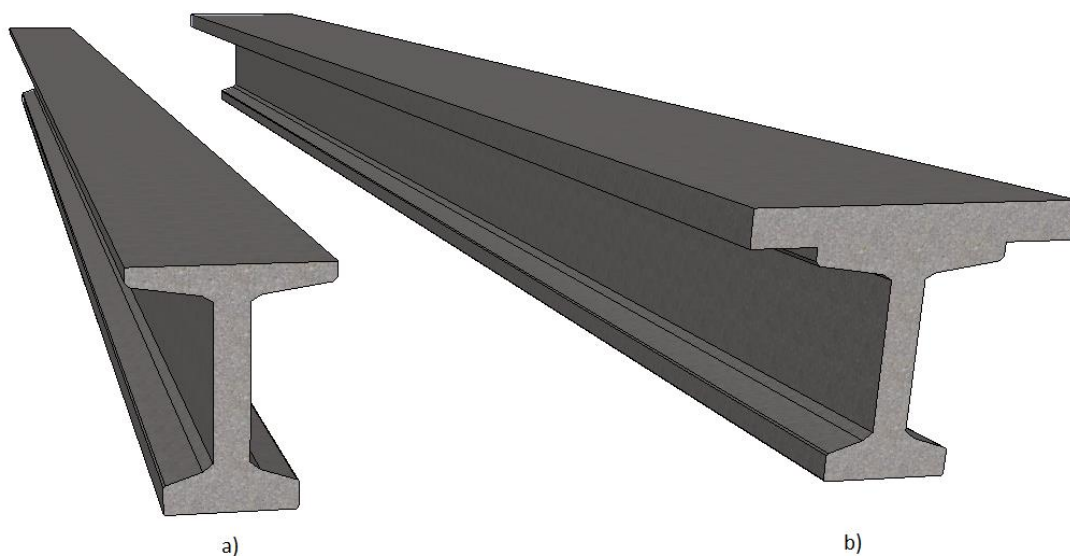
a) viga com secção transversal I; b) Secção da viga composta (Viga + banzo comprimido)
